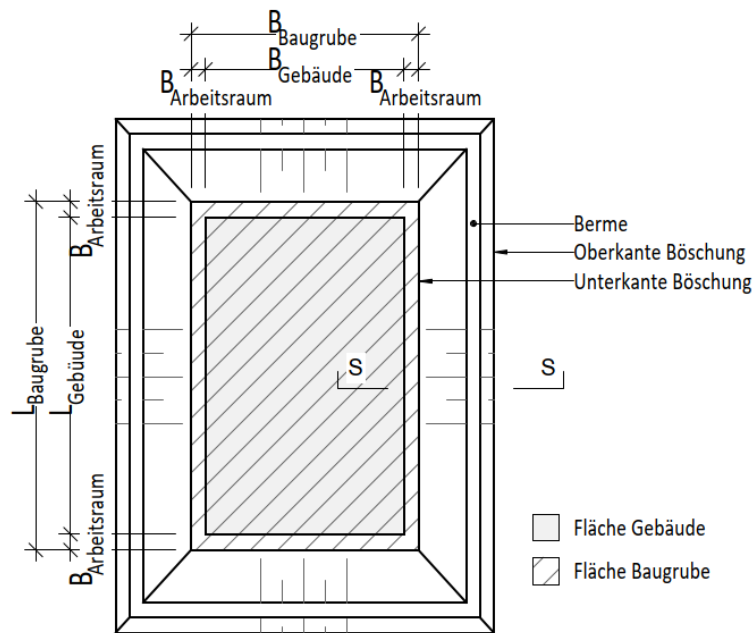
Schematische Darstellung Grundriss Baugrube (gebösch)
